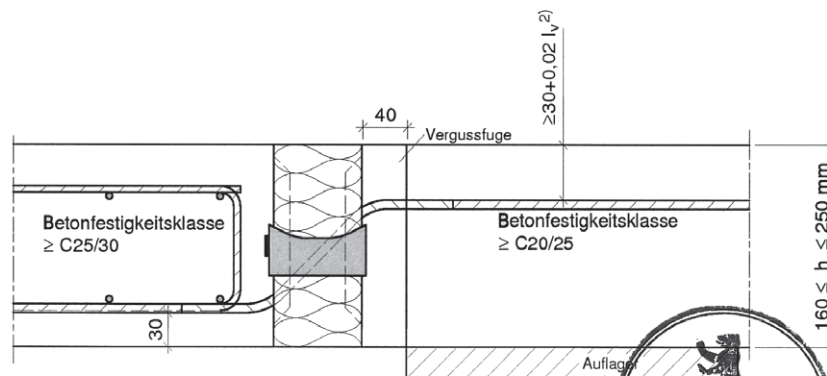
Beispiel Schöck Isokorb Typ RQ-240 in eingebautem Zustand mit Vergussfuge
